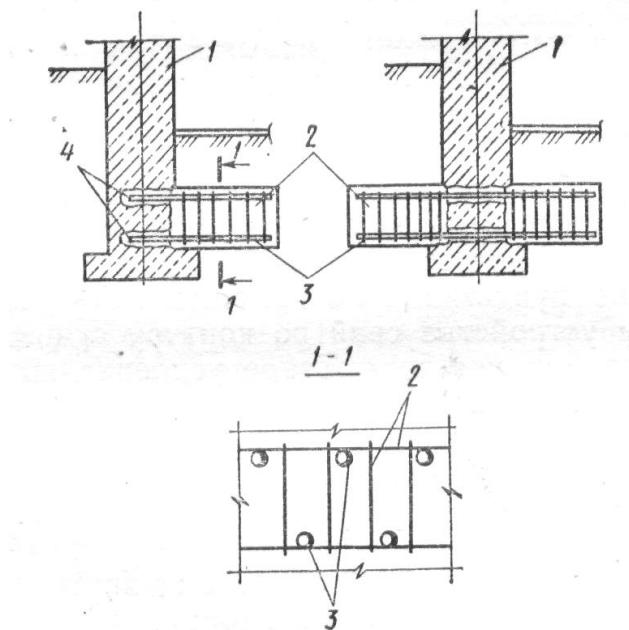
Посилення стрічкового фундаменту підведенням
